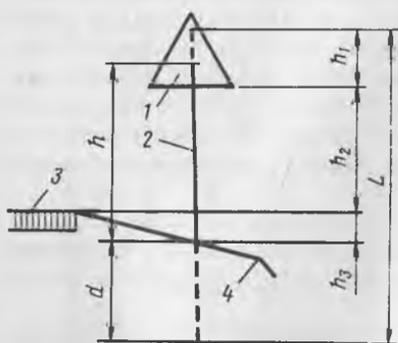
Расчетная схема опоры для установки дорожных знаков: 1 — дорожный знак; 2 — опора; 3 — дорожное покрытие; 4 — присыпанная берма
